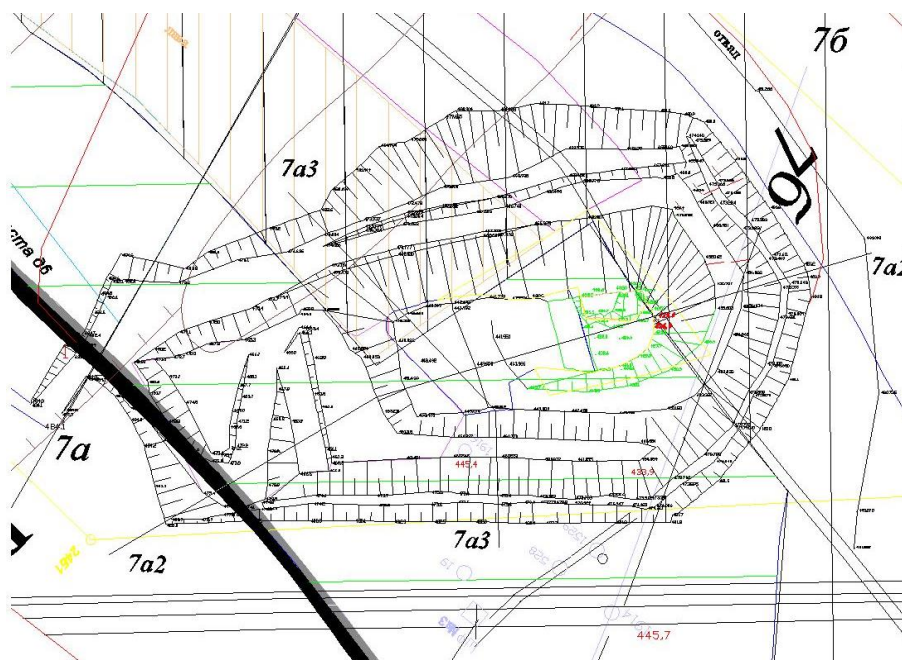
План горных работ на момент начала отработки выхода угольного пласта
